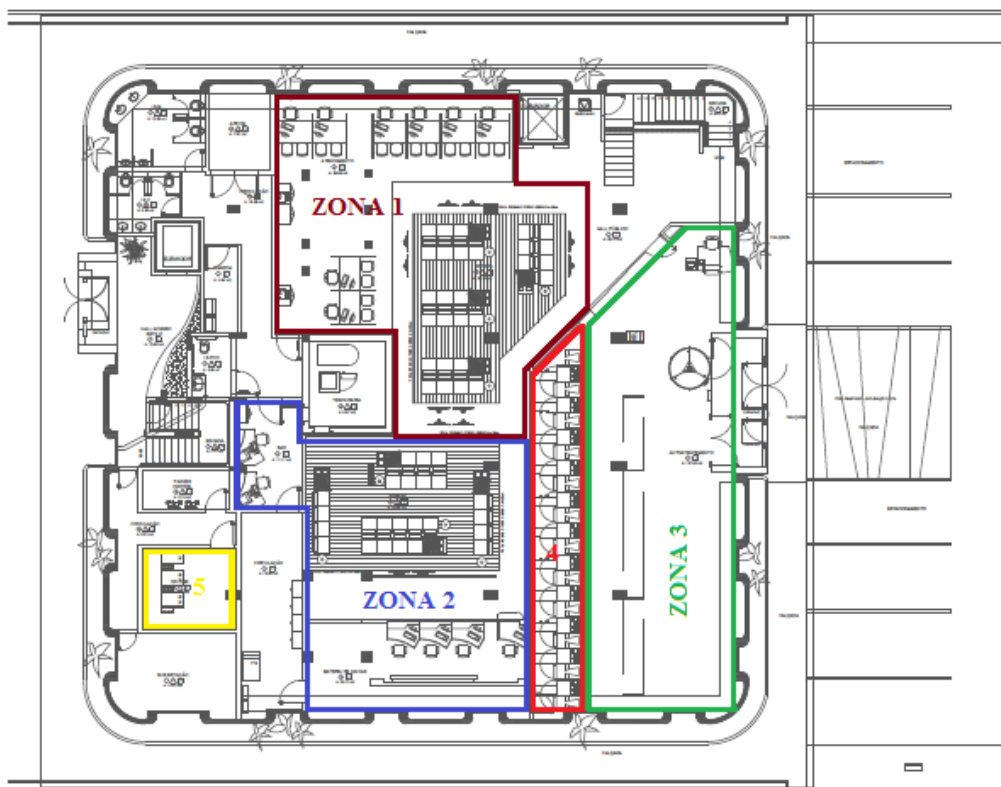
Zonas térmicas pavimento térreo (O Autor, 2014)
